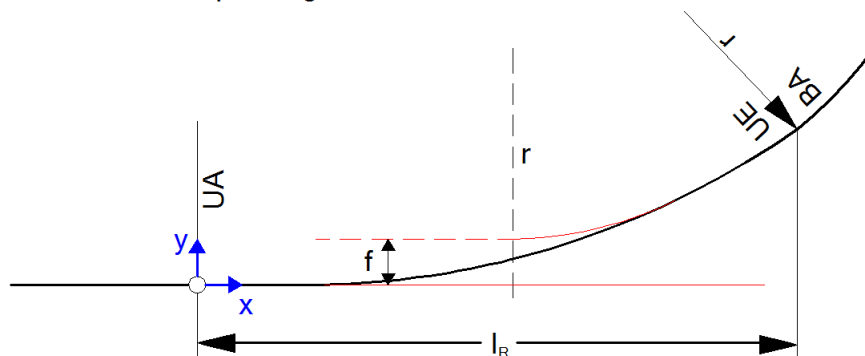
Grundriss einer kubischen Parabel [40]
